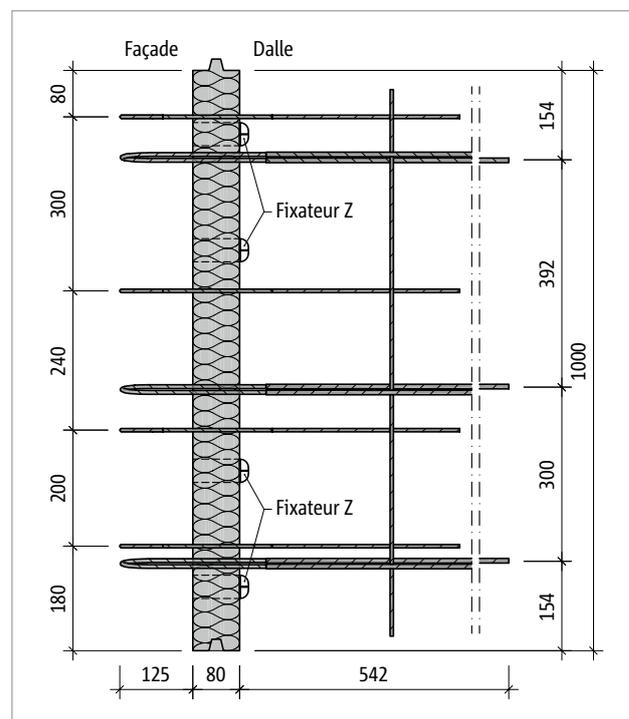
Schöck Rutherma® T type DFi-V3-LR125 : vue en plan du produit
